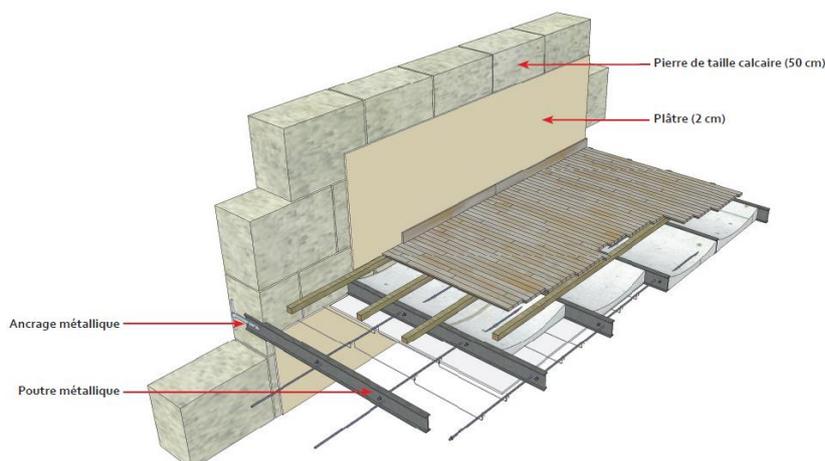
Coupe de mur : façade porteuse sur rue en pierre de taille (calcaire) et plancher avec poutre métallique et remplissage plâtre, APUR, 2011.
